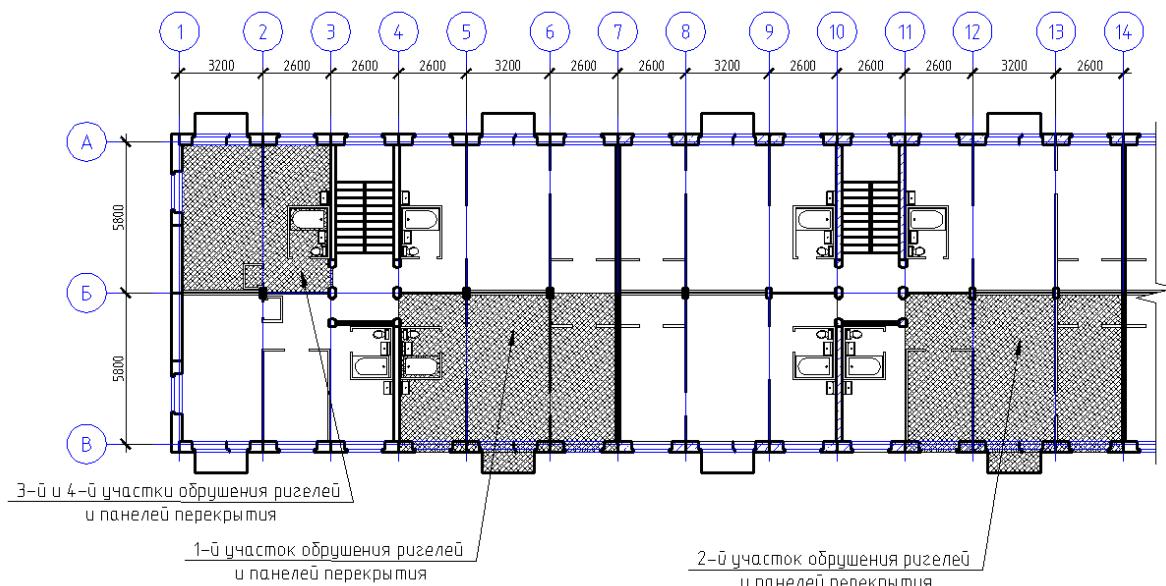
Локальные разрушения ригелей и панелей перекрытия
